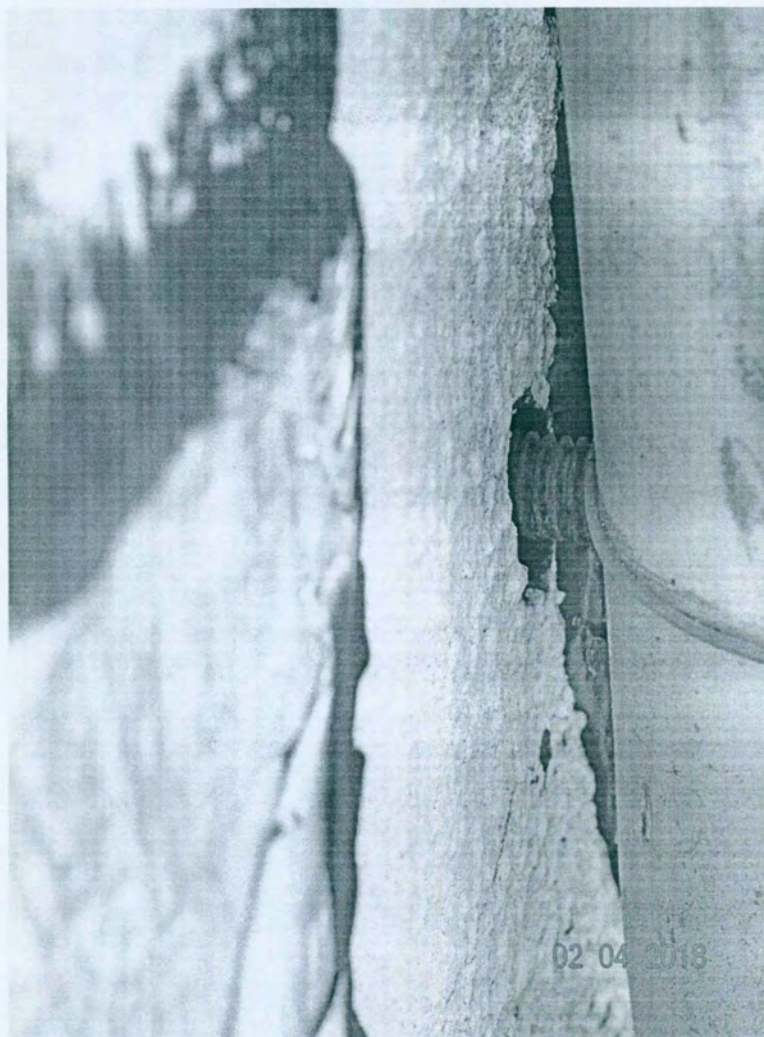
Detalhe da fixação da antena, sem impermeabilização e com abertura que permite a entrada de água.
